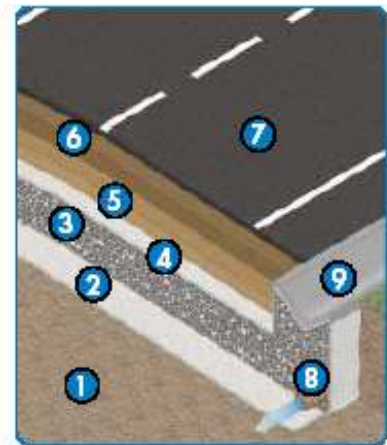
Sección constructiva típica de las capas de un pavimento flexible.
